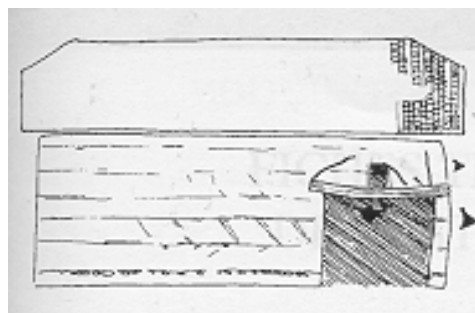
Fissuras devido a deflexão da viga
